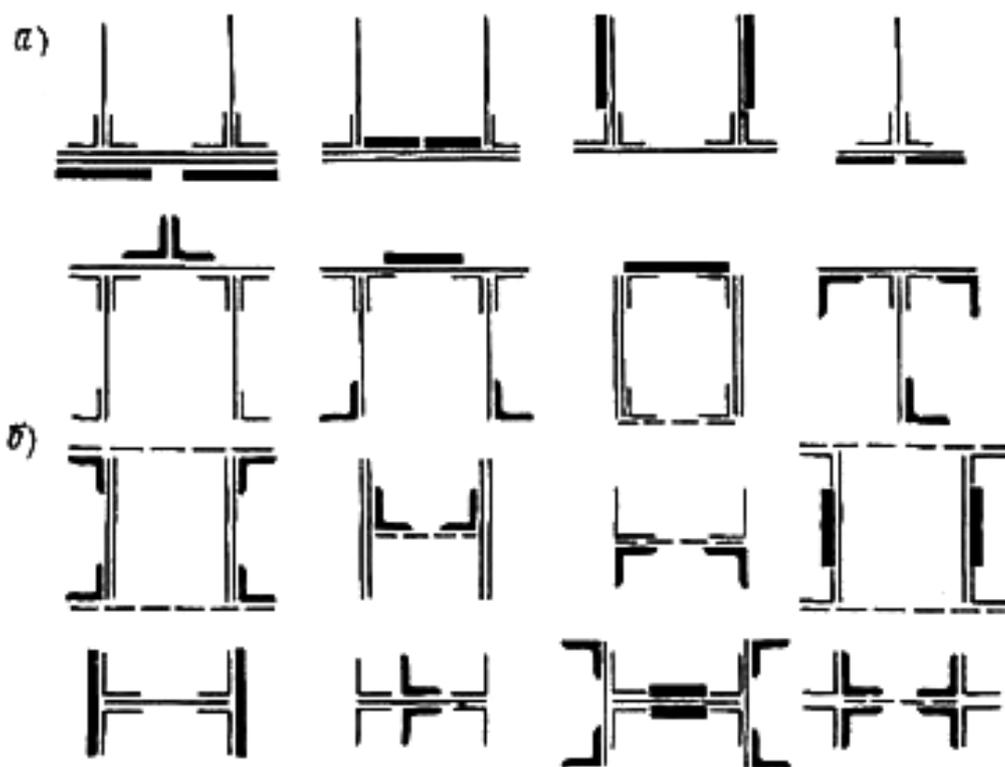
Схемы усиления сечений элементов сквозных ферм: а – поясов; б – раскосов, стоек и подвесок
